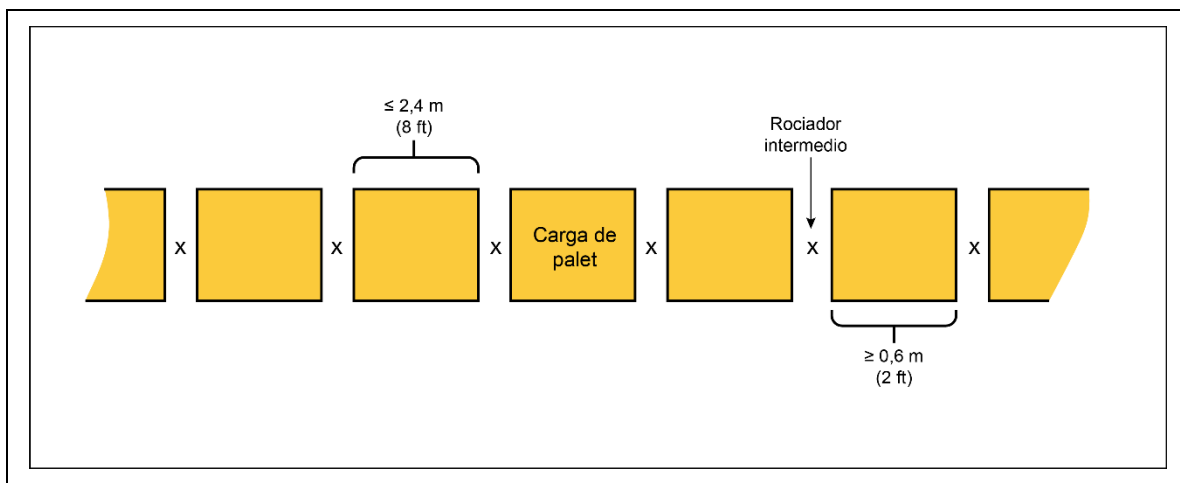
Vista en planta de una configuración horizontal de rociadores intermedios en cada chimenea transversal para estanterías simples
